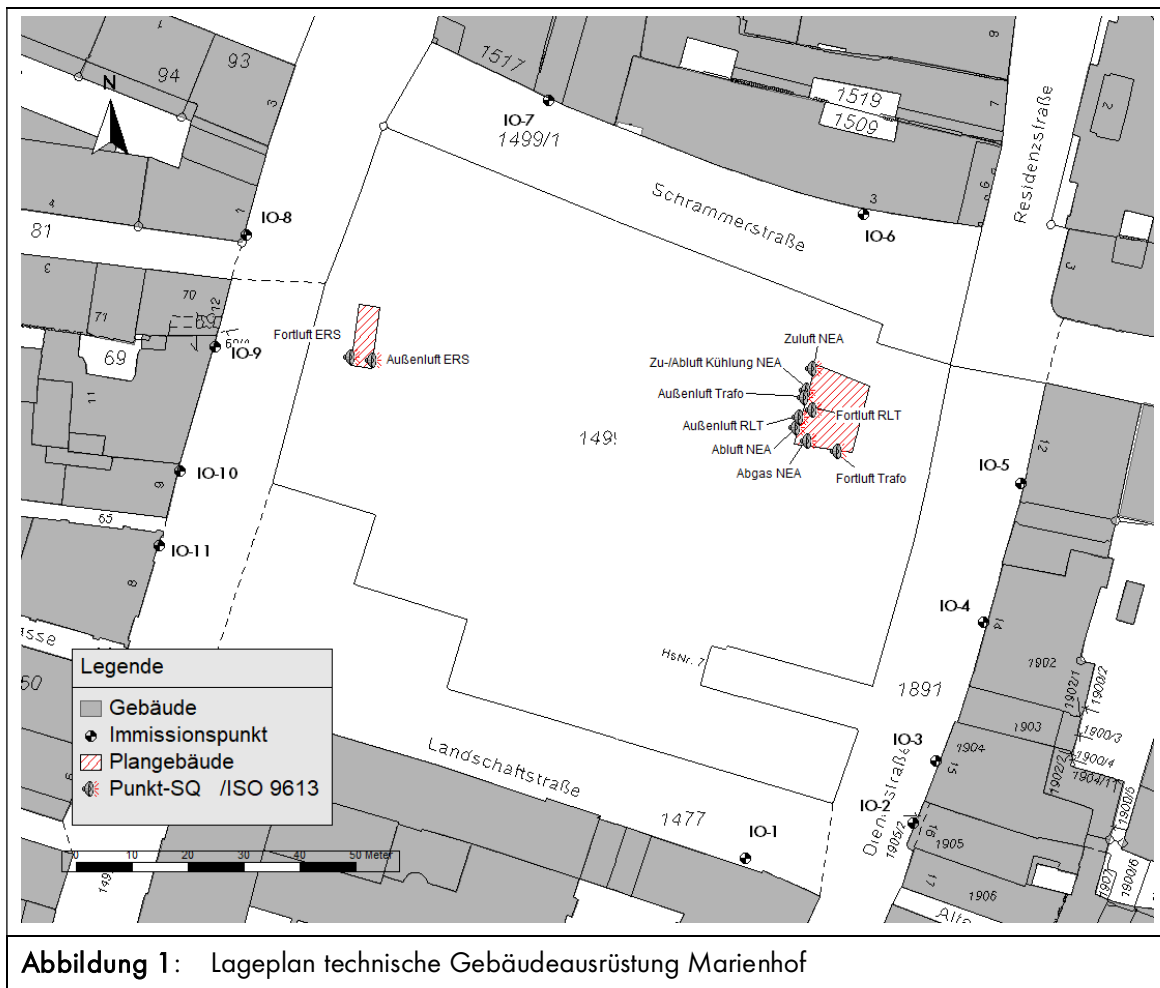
Lageplan technische Gebäudeausrüstung Marienhof
